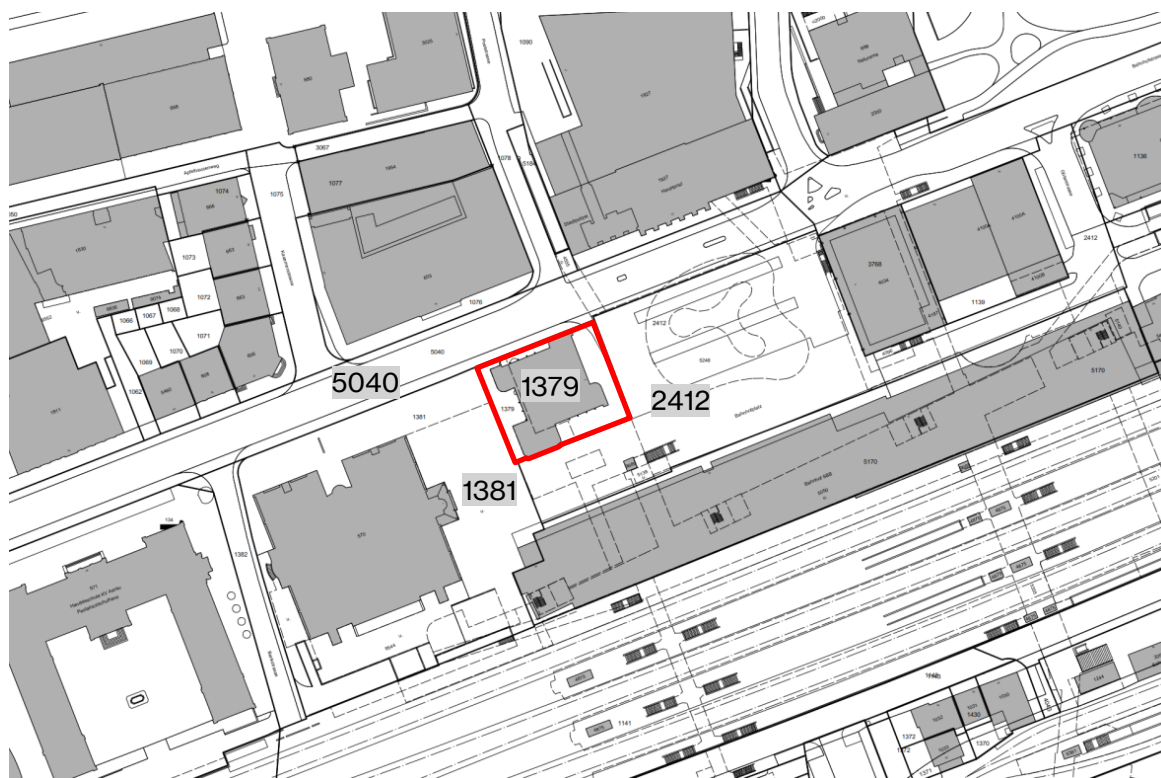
Situationsplan mit Planungsgebiet (rot bandiert, Quelle Agis)
